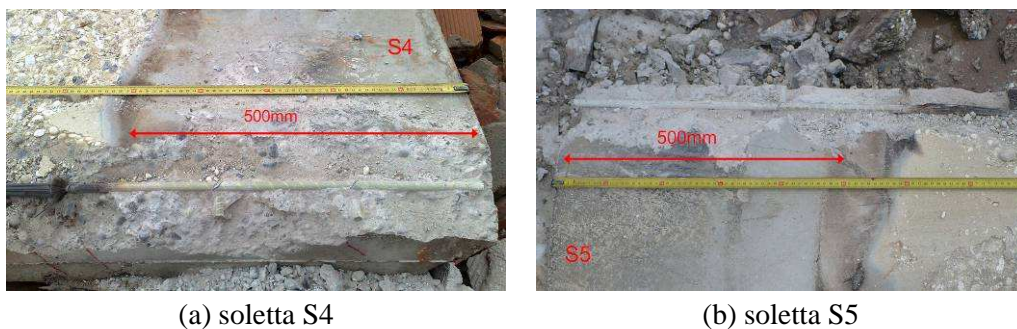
Verifica dello stato delle armature nella zona di ancoraggio
